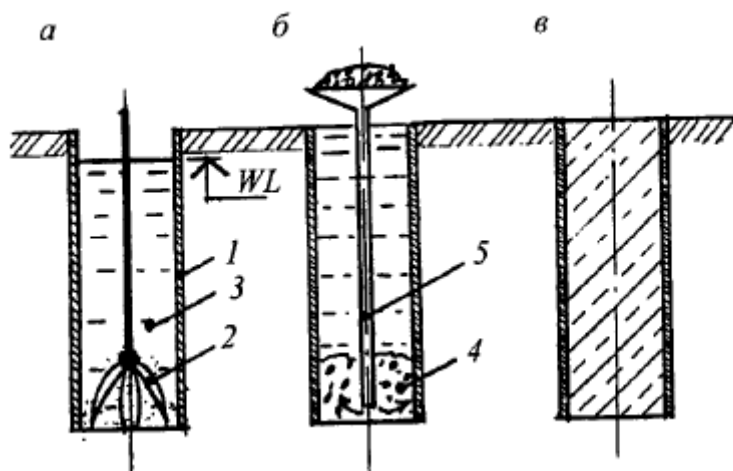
Последовательность изготовления буровой сваи (свай-столба); а - разработка грунта внутри оболочки грейферным ковшом; б - бетонирование внутренней полости оболочки метолом ВПТ; в - готовая свая-столб; 1 - оболочка; 2 - грейферный ковш; 3 - вода; 4 - бетон; 5 - бетонолитная труба
